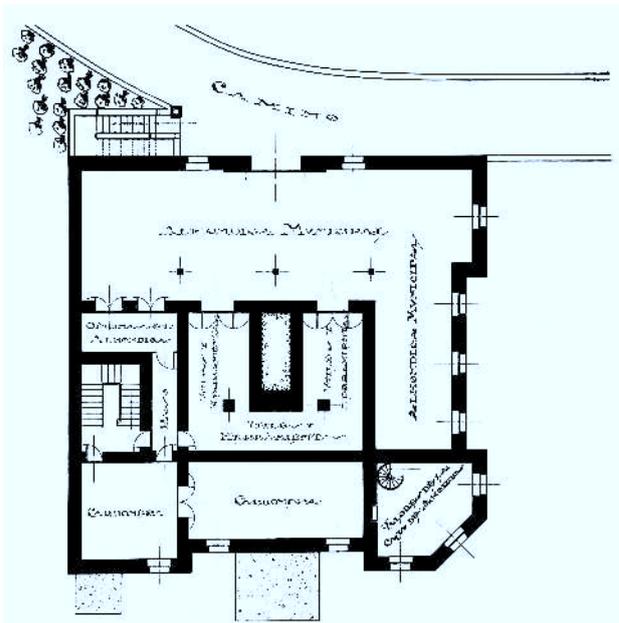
Proyecto para el Ayuntamiento de Carranza realizado en 1924 por el arquitecto Julio Sáenz de Barés. Planta del sótano. (Edificio no construido).
